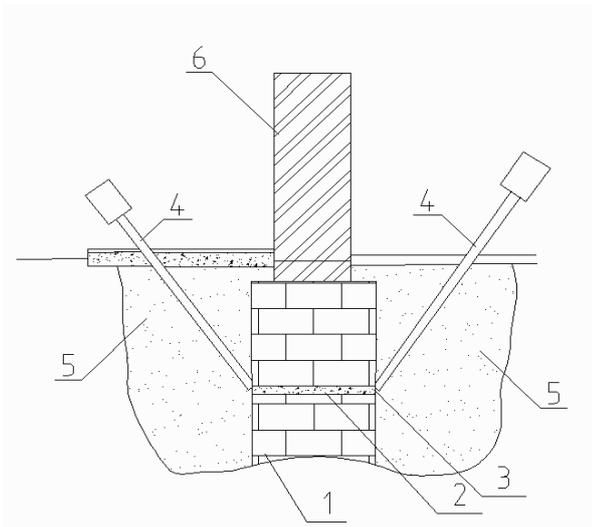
Устранение разрыва ленточного фундамента цементным раствором: 1 – усиливаемый фундамент; 2 – разрыв фундамента вследствие морозного пучения и просадки грунта основания; 3 – жидкий цементный раствор; 4 – иньекторы; 5 – непучинистый грунт; 6 – кирпичная стена
